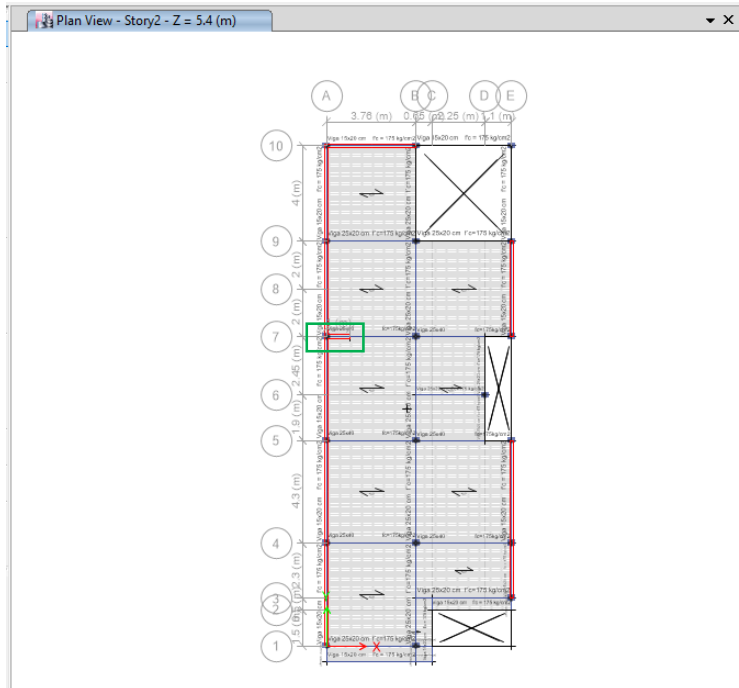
Vista en planta de la vivienda 3 reforzada con placa de concreto armado. Fuente: propia.
